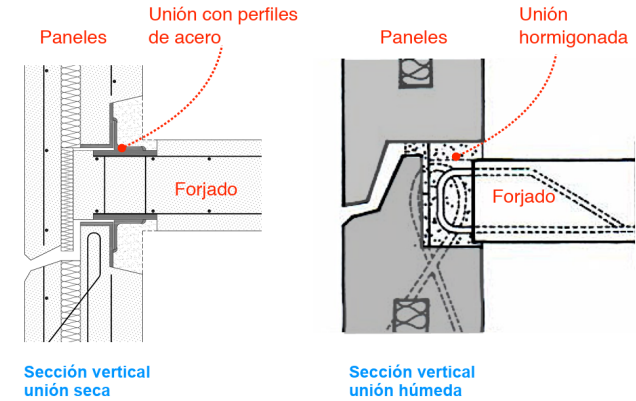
Fijación de Paneles Prefabricados de Hormigón.
